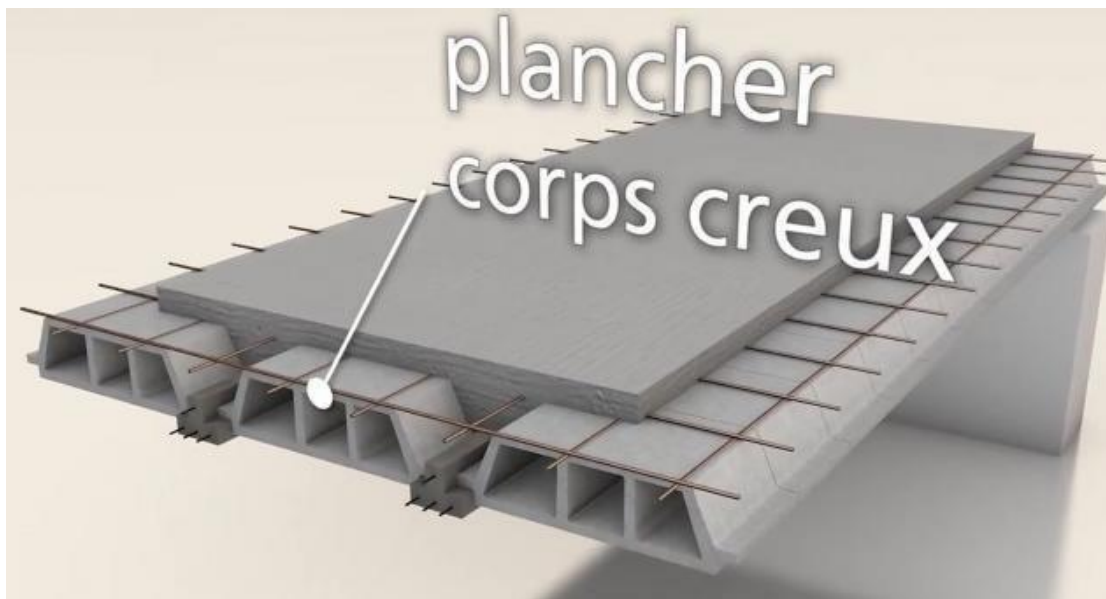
Les éléments principaux d'un plancher à corps creux
